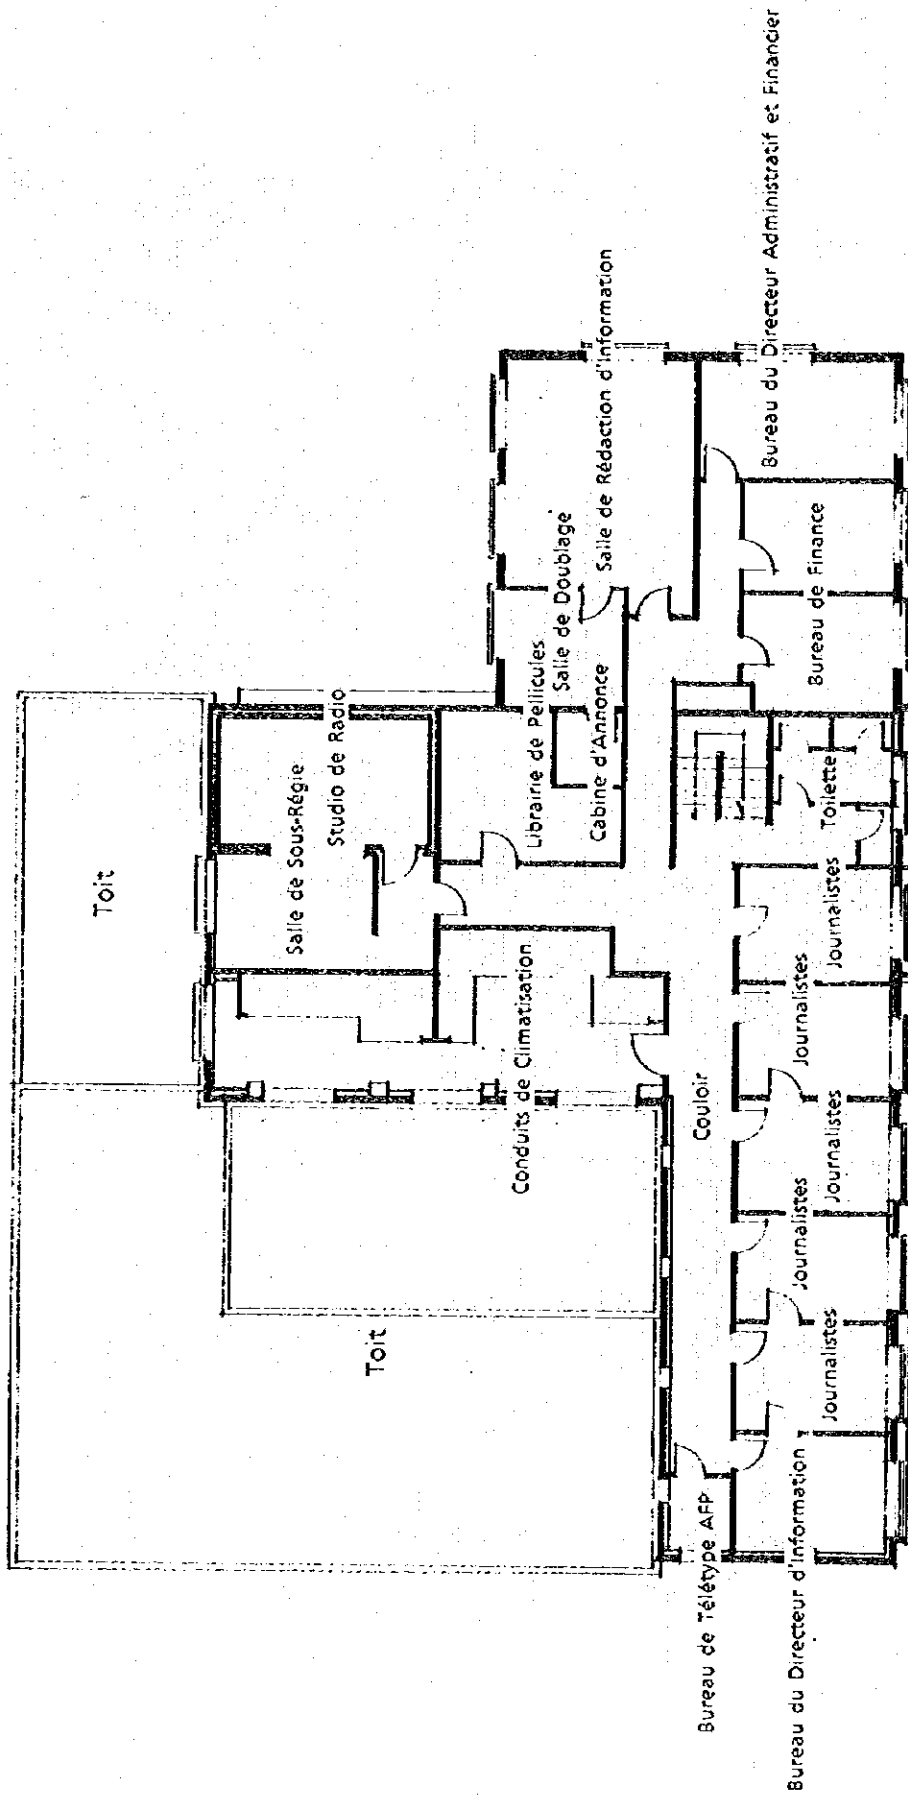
PLAN DU DEUXIEME ETAGE DU BATIMENT EXISTANT
